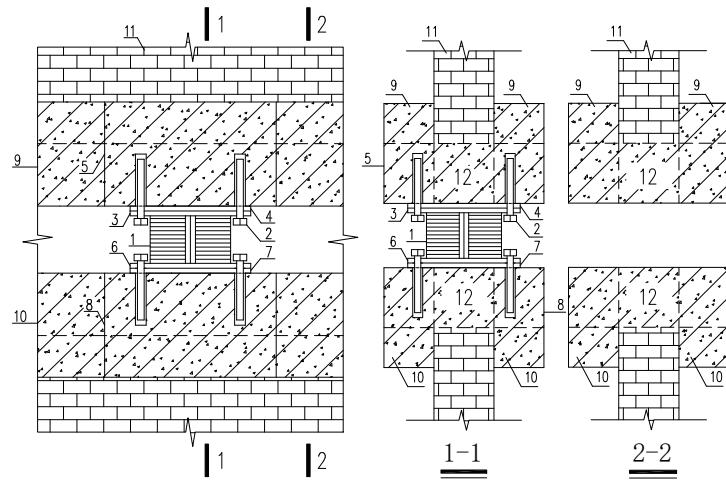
双夹梁墙体托换及隔震支座安装示意图
